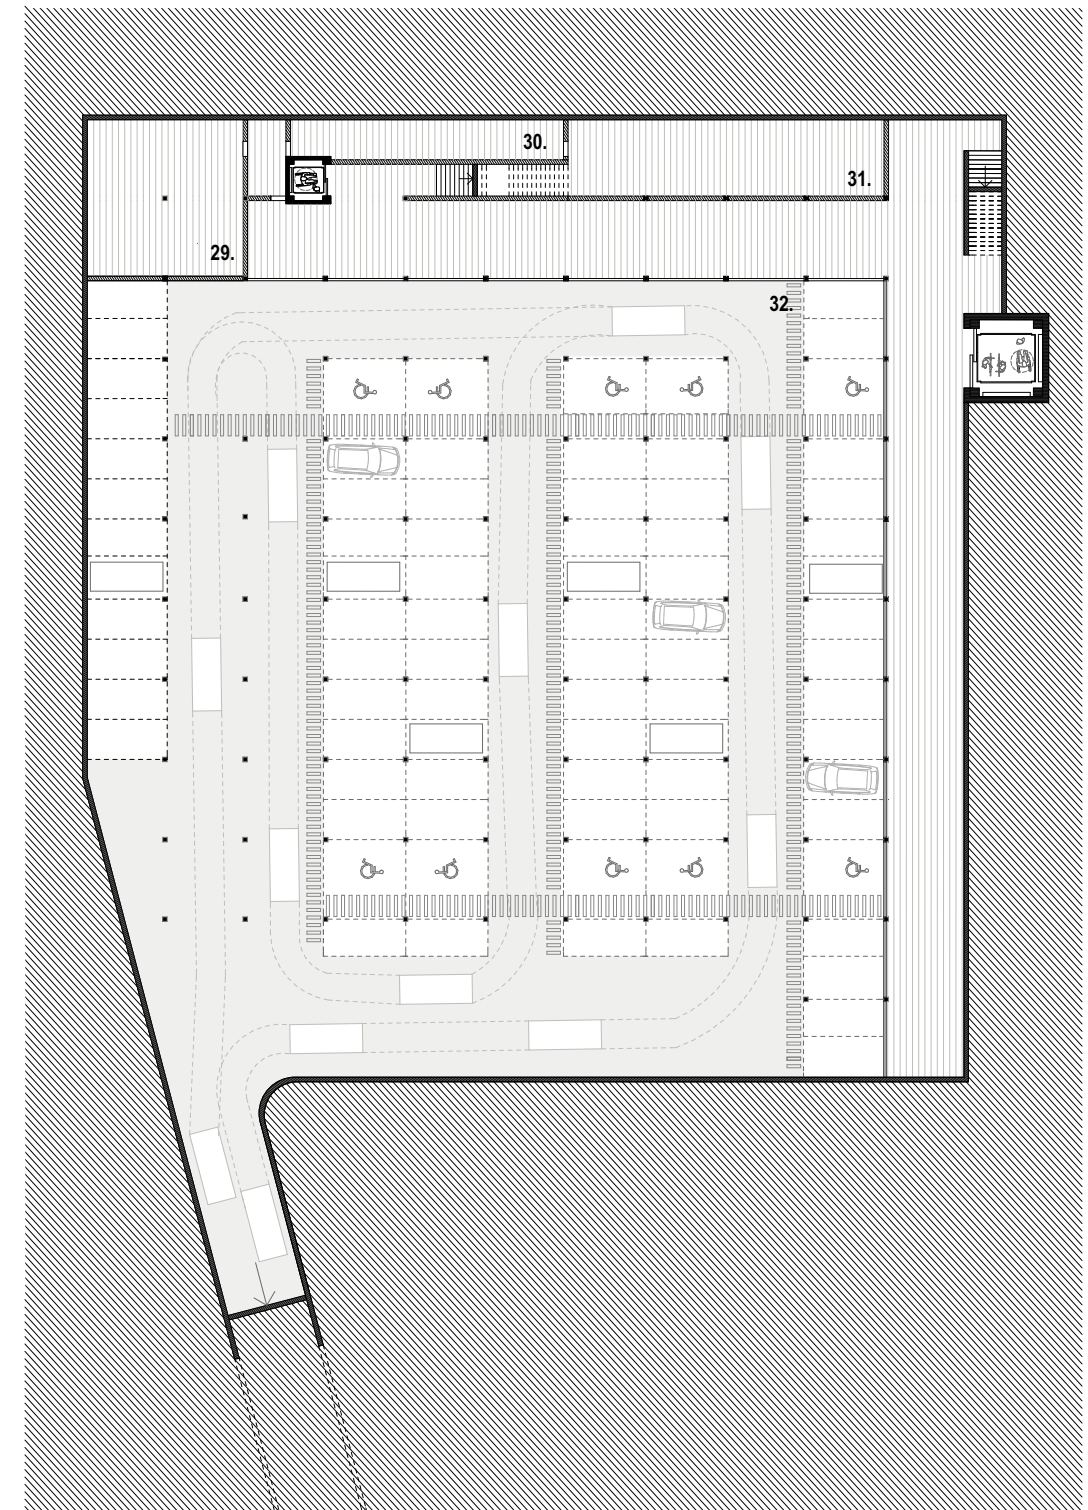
Planta do piso -1 - Estacionamento Subterrâneo (cota 57)
